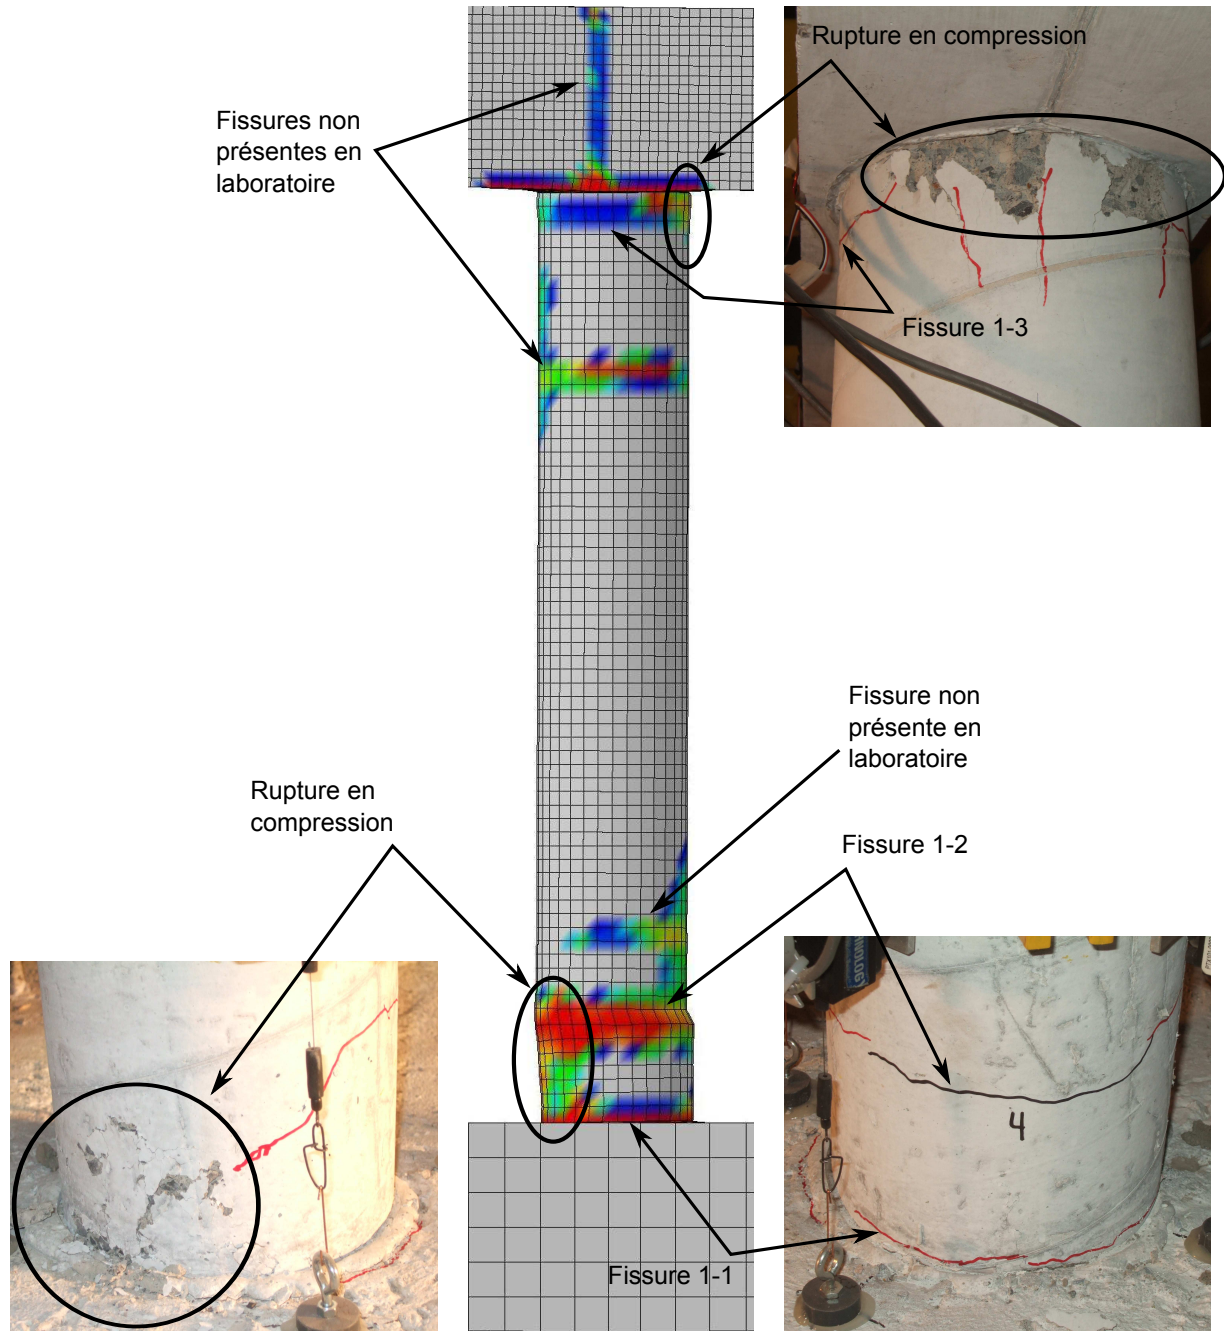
Endommagement du poteau 1 de la pile 02 suite à l'essai
